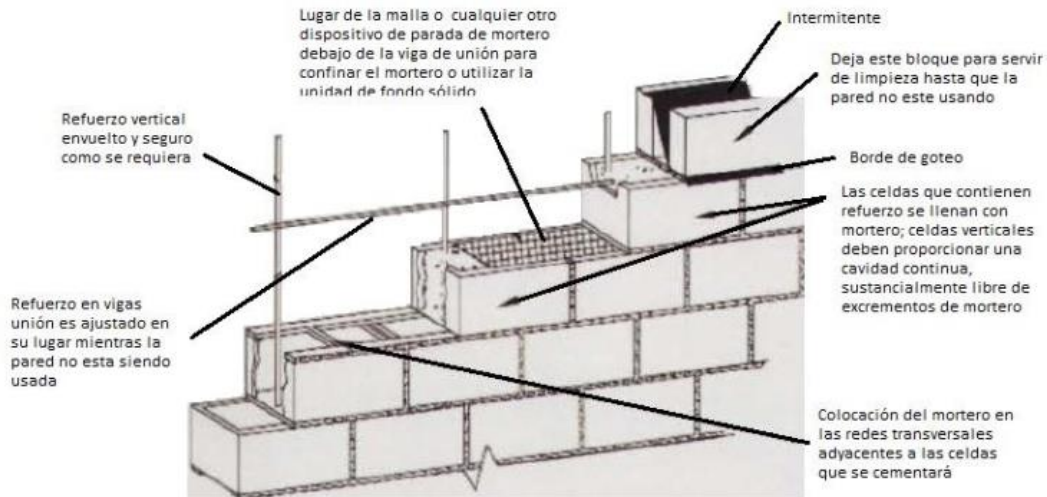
Refuerzo típico de una sección de pared de mampostería reforzada
